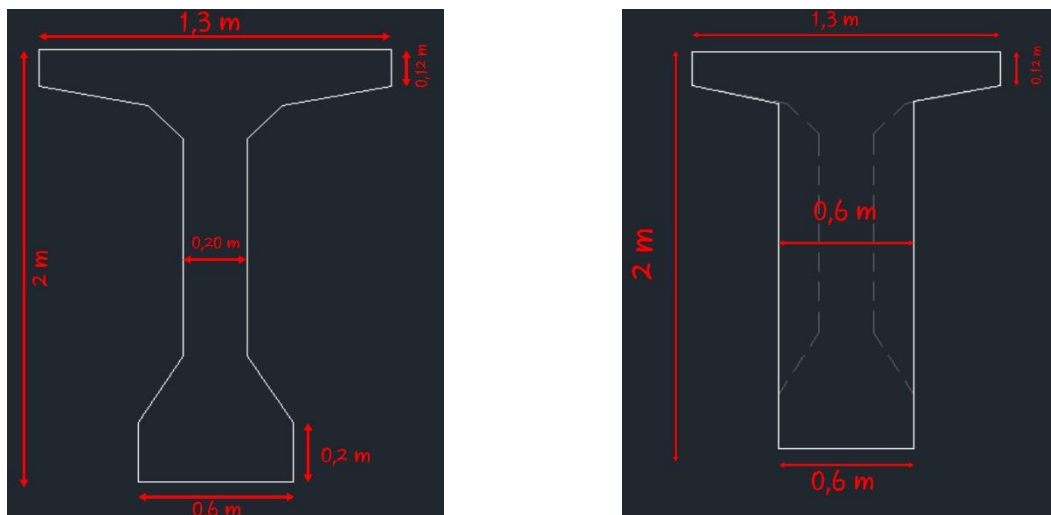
Coupe de section à mi-travée à gauche et coupe de section sur appui à droite
